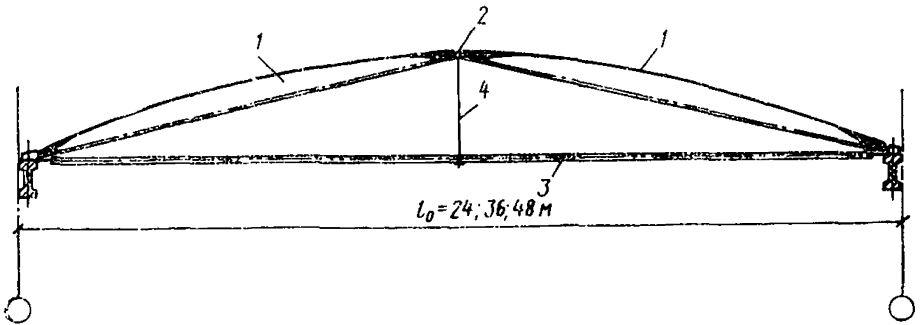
Конструктивная схема сегментного свода для покрытий, опирающегося на продольные балки каркаса здания
